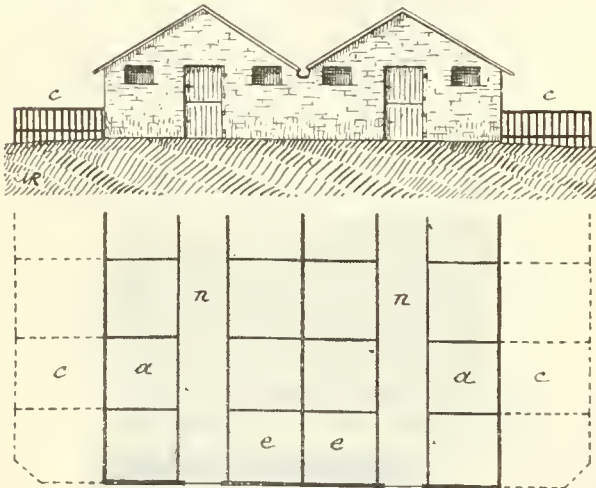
Élévation et plan d'une porcherie d'élevage et d'engraissement à quatre rangs de loges.
